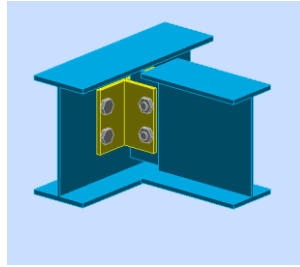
Pormenor da Ligação Viga Principal – Viga Interior (IPE 240 – IPE 220).
